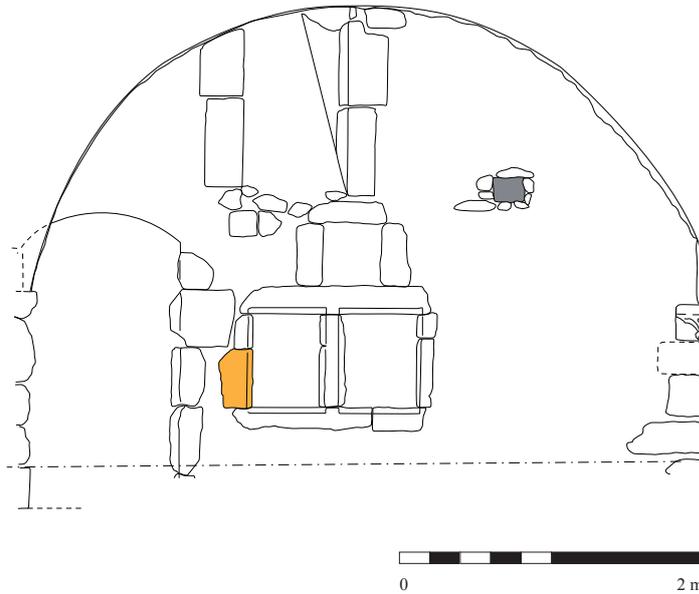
Élévation du mur Est de la cave avec les principales unités de construction (relevé S. Bryant, Inrap et A. Prévot, Inrap).
